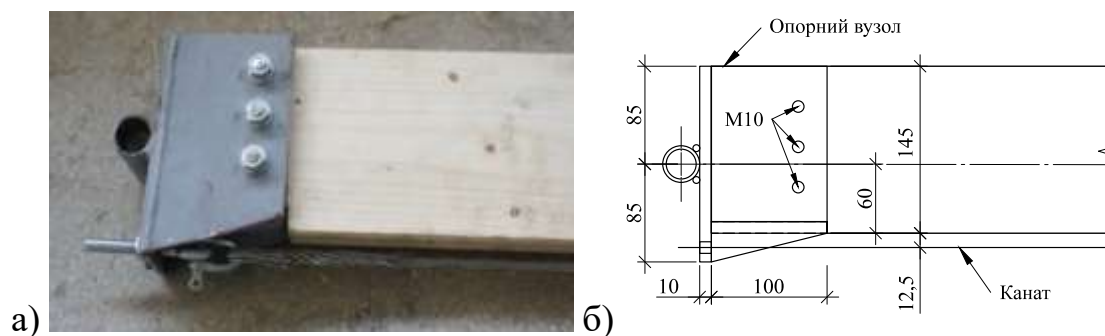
Опорний вузол; а) загальний вигляд; б) конструктивна схема
